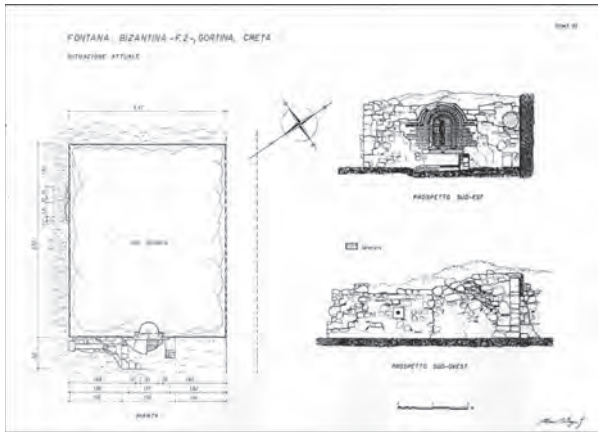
Planimetria e prospetti della cisterne/fontana nr. 78 (A. Ortega 1989, Archivio SAIA).
